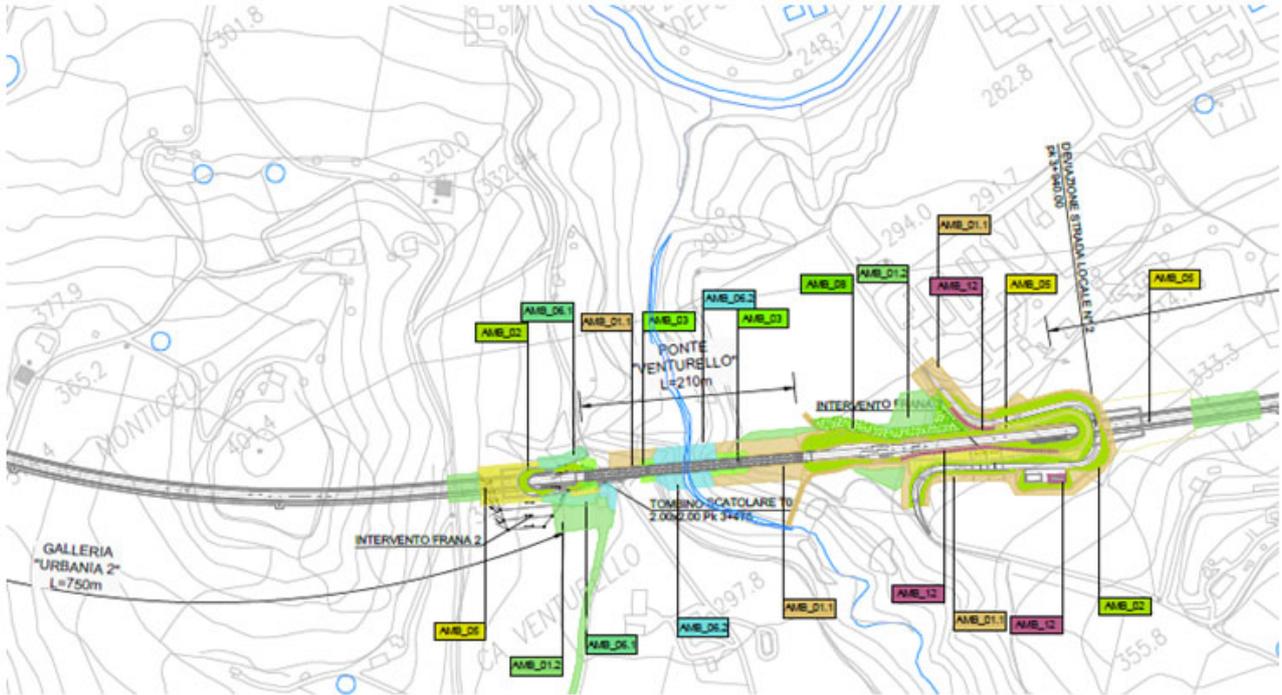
Estratto planimetria interventi di mitigazione - Planimetria di insieme (T00IA03AMBPL01_B)
